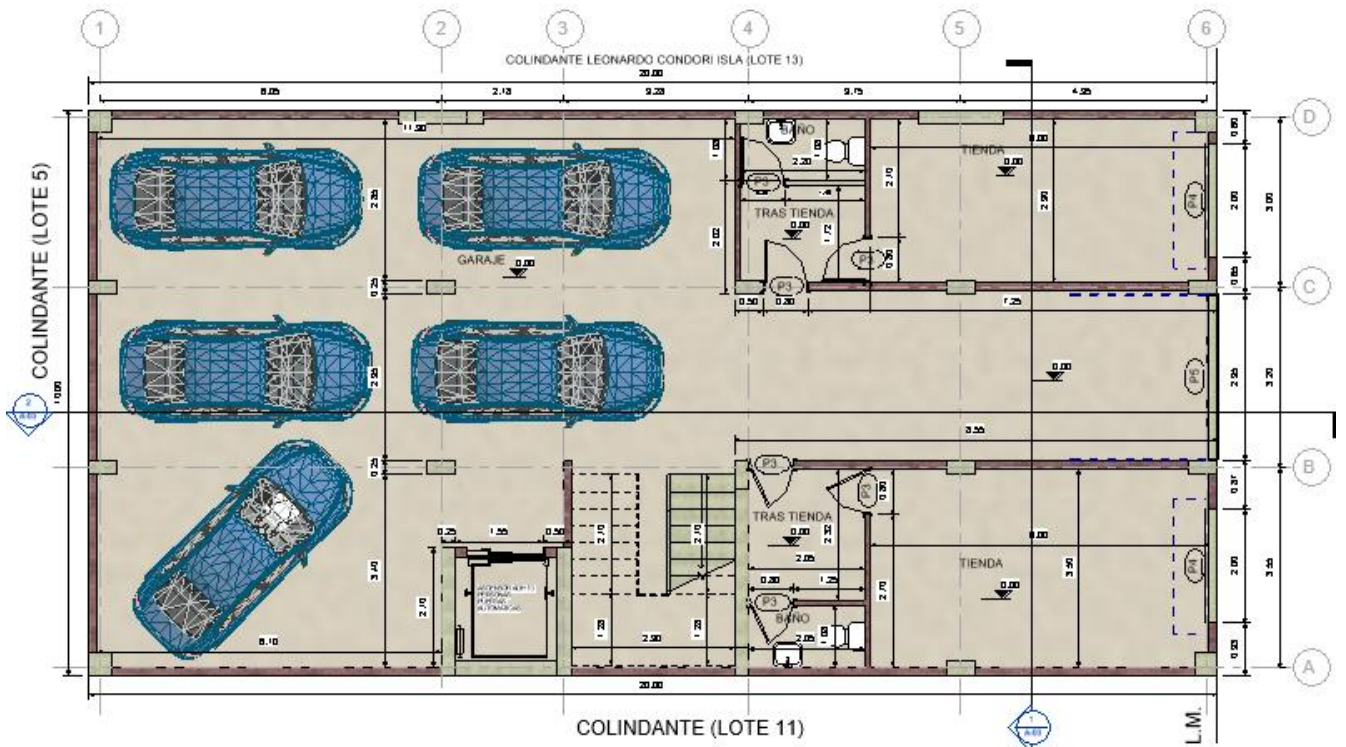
Vista en planta del nivel de semisótano realizado en revit 2021
